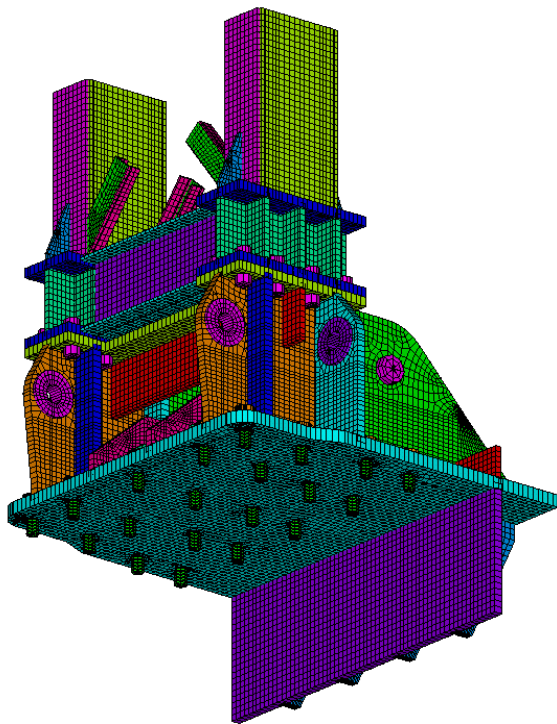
MEF. Encuentro de puntal inclinado y vertical a pila de hormigón.
